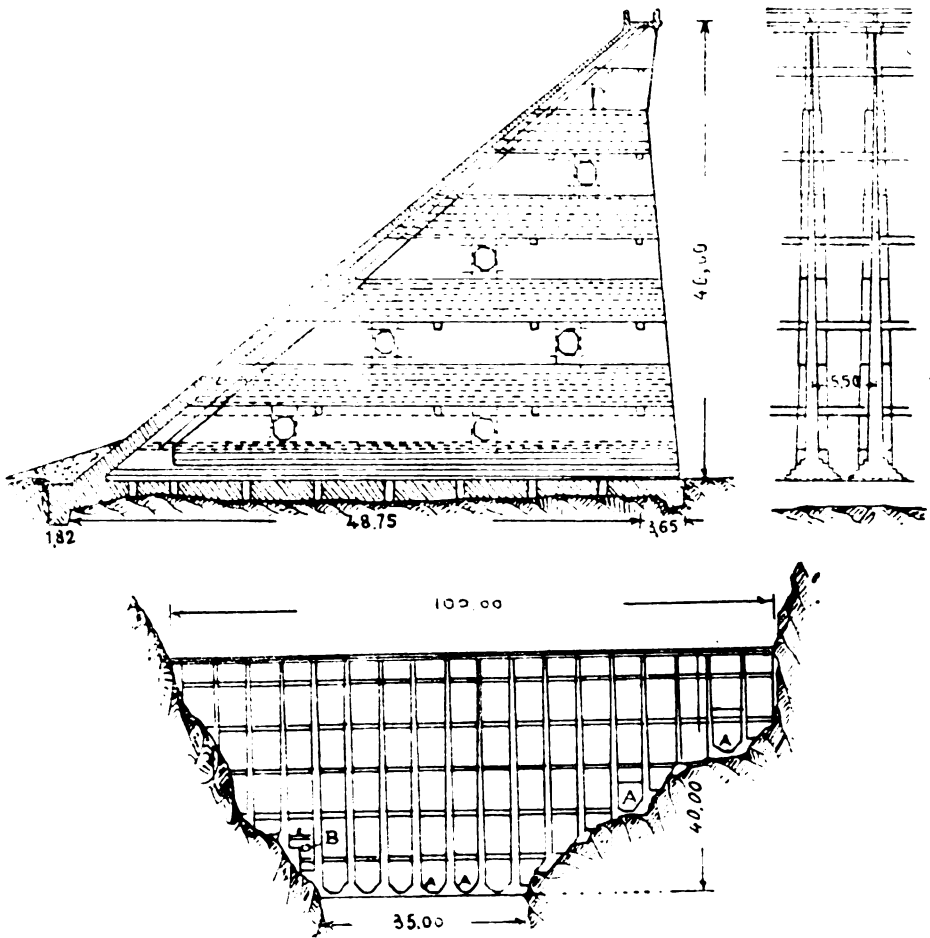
Diga in cemento armato di La Prele (Stati Uniti).
